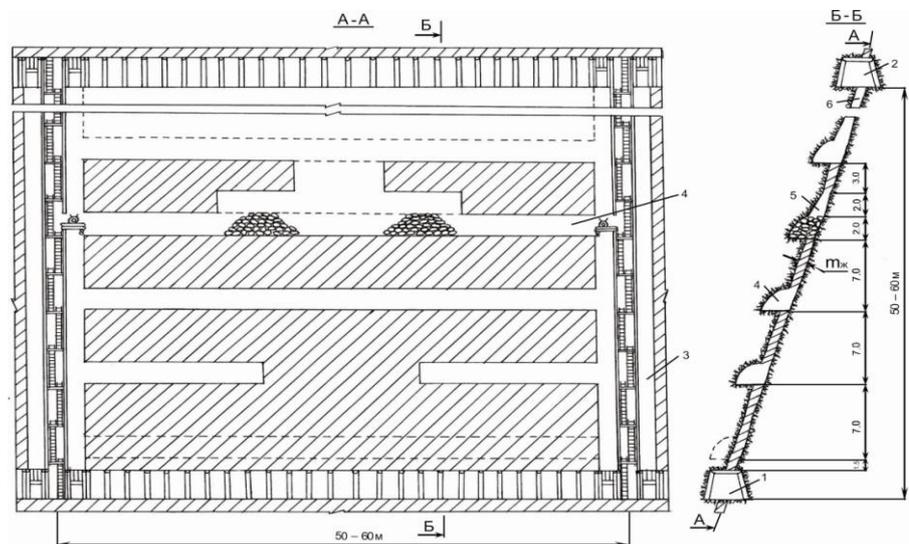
Система разработки подэтажными штреками со щелевой выемкой руды: 1 - откаточный штрек; 2 - вентиляционный штрек; 3 - блоковый восстающий; 4 - подэтажные штреки; 5 - первичная щель; 6 - вторичная щель
